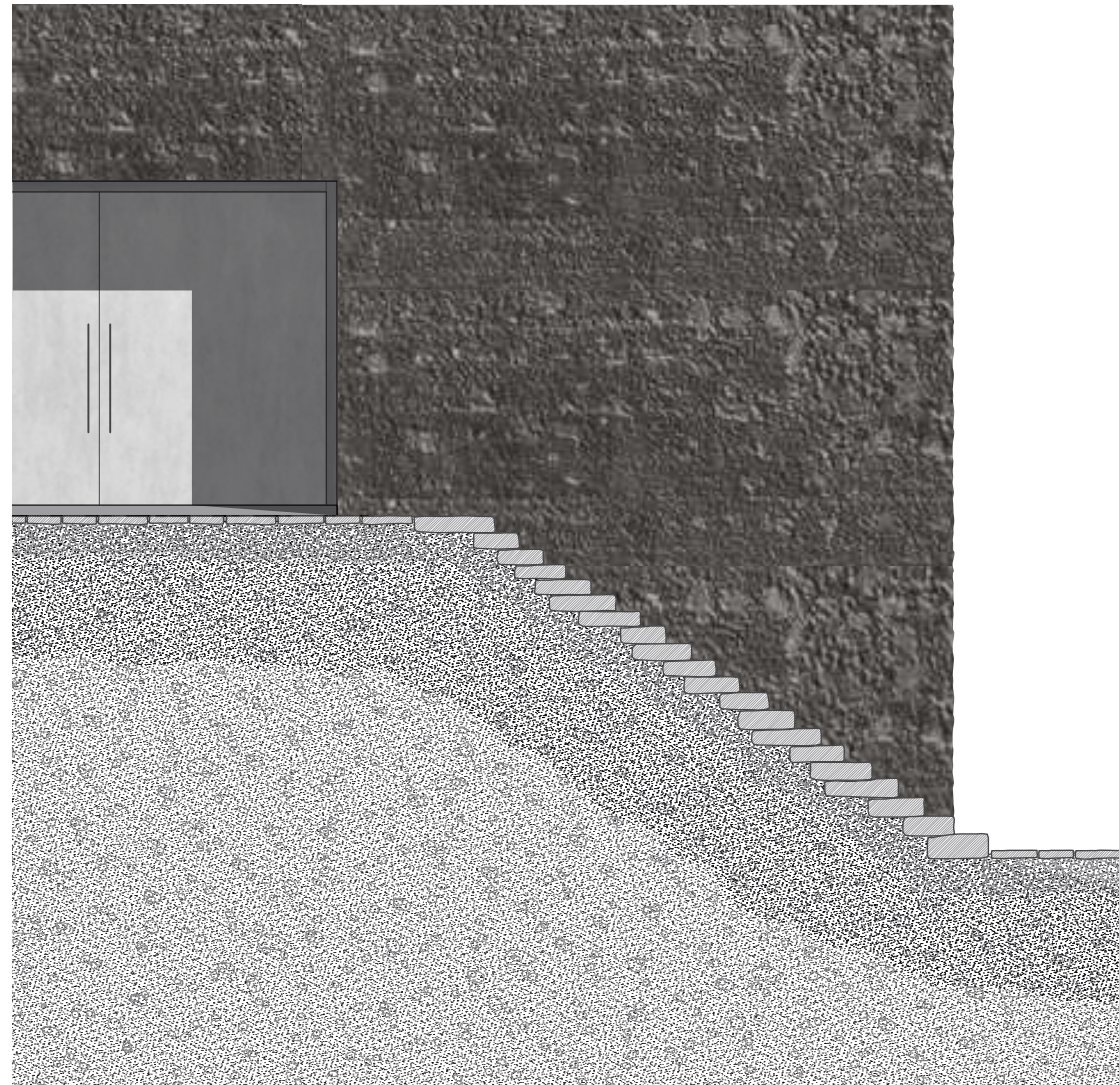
Teilansicht der Westfassade, Ausfahrt und Schnitt durch die aus Basalt-Blöcken bestehende Stiege
